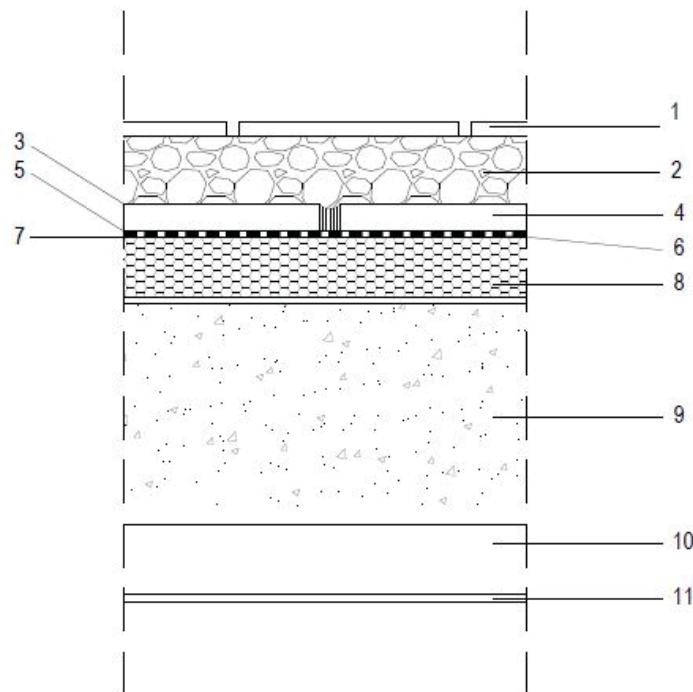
Detalle cubierta invertida 1. Fuente: Elaboración propia-CAD
